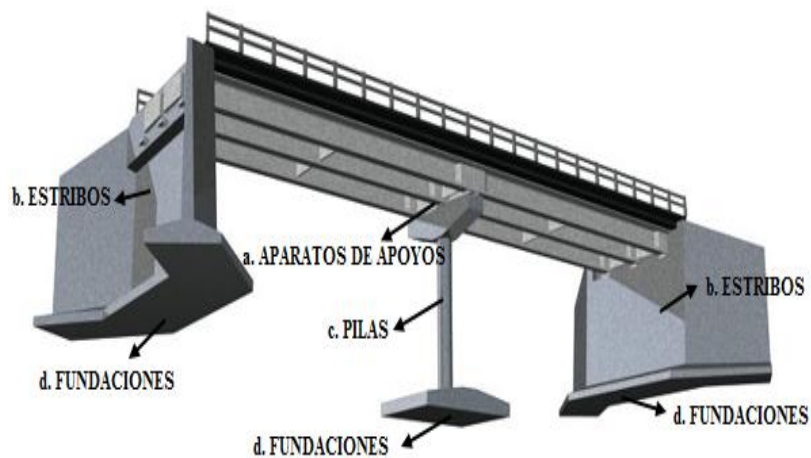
ELEMENTOS PRINCIPALES DE LA SUBESTRUCTURA.
